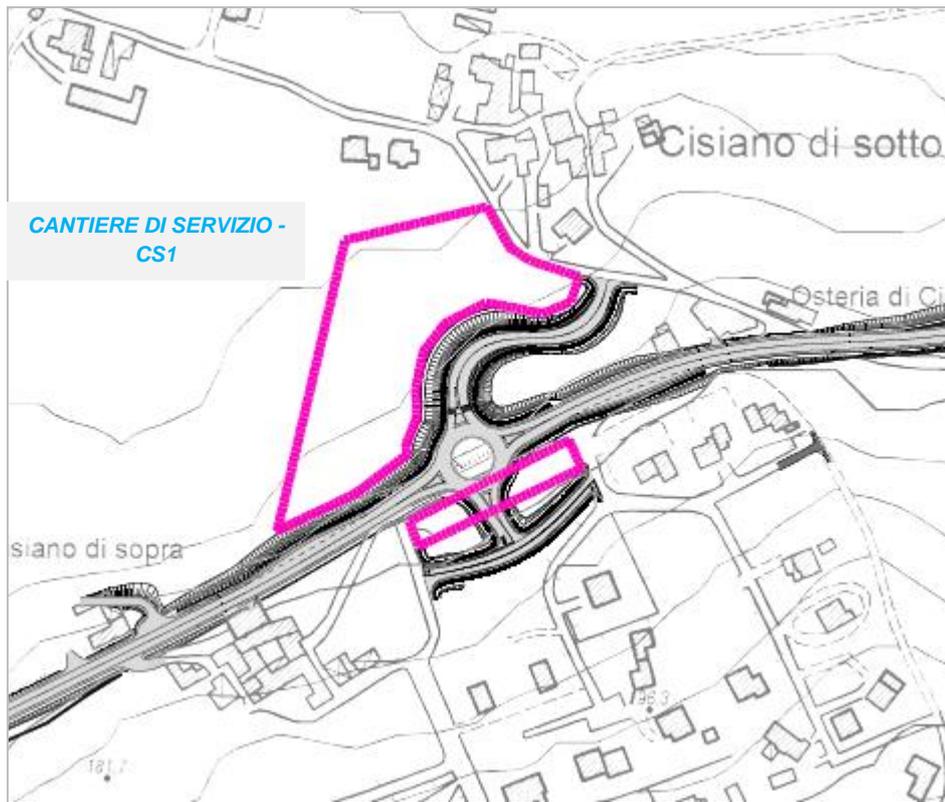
PLANIMETRIA CANTIERE DI SERVIZIO CS1
